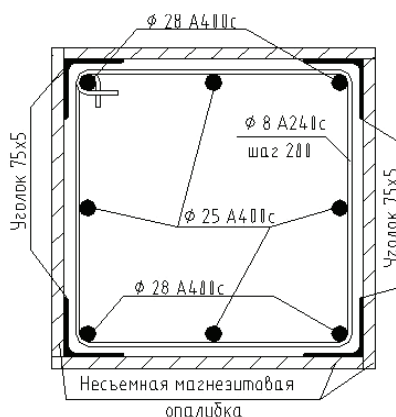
Армирование монолитной железобетонной колонны уголками в несъемной опалубке в виде магнезитовых плит
